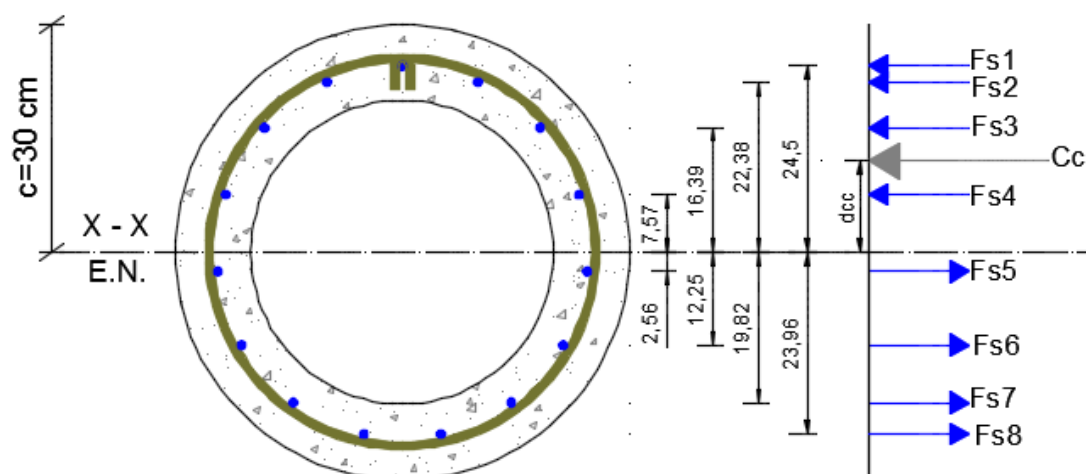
Esquema general de deformaciones, esfuerzos y fuerzas en la sección transversal circular
